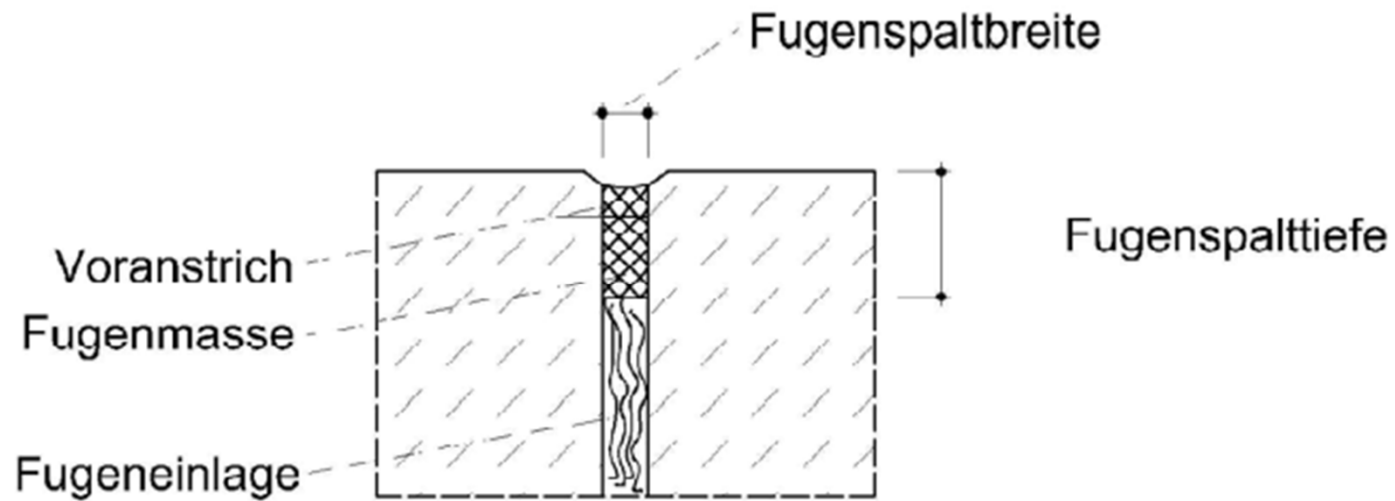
Raumfuge in Fahrbahndecken aus Beton
